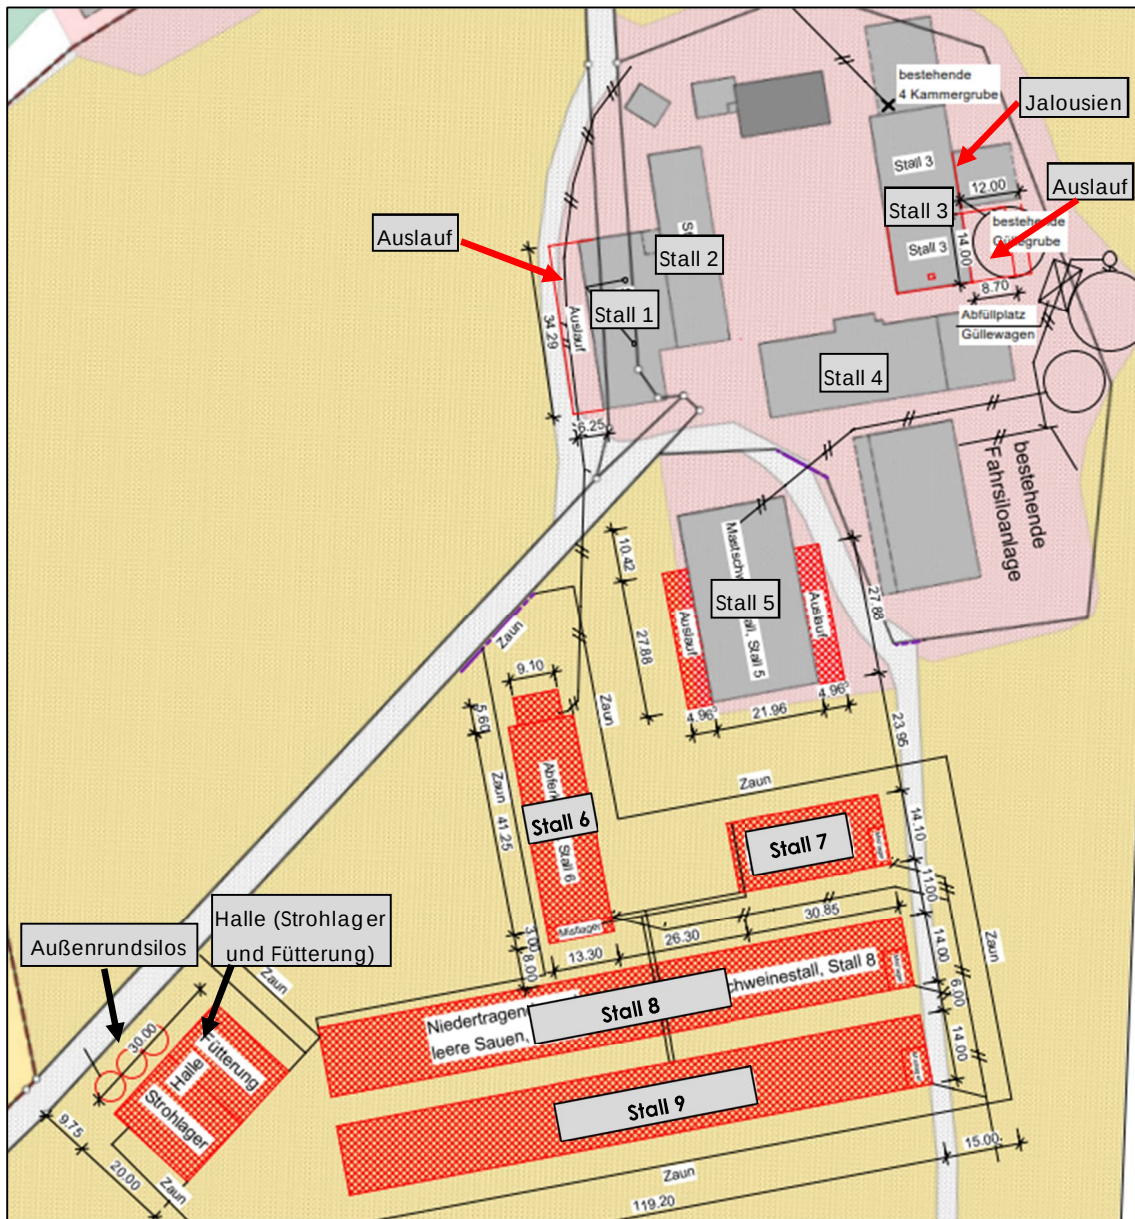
Lageplan des geplanten Gesamtbetriebs (Neue Gebäude und Änderungen in rot),
